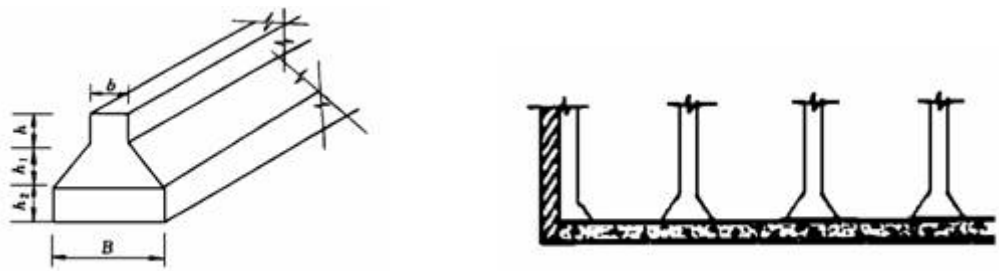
混凝土条形基础示意图 图 5.38 无梁式满堂基础示意图
